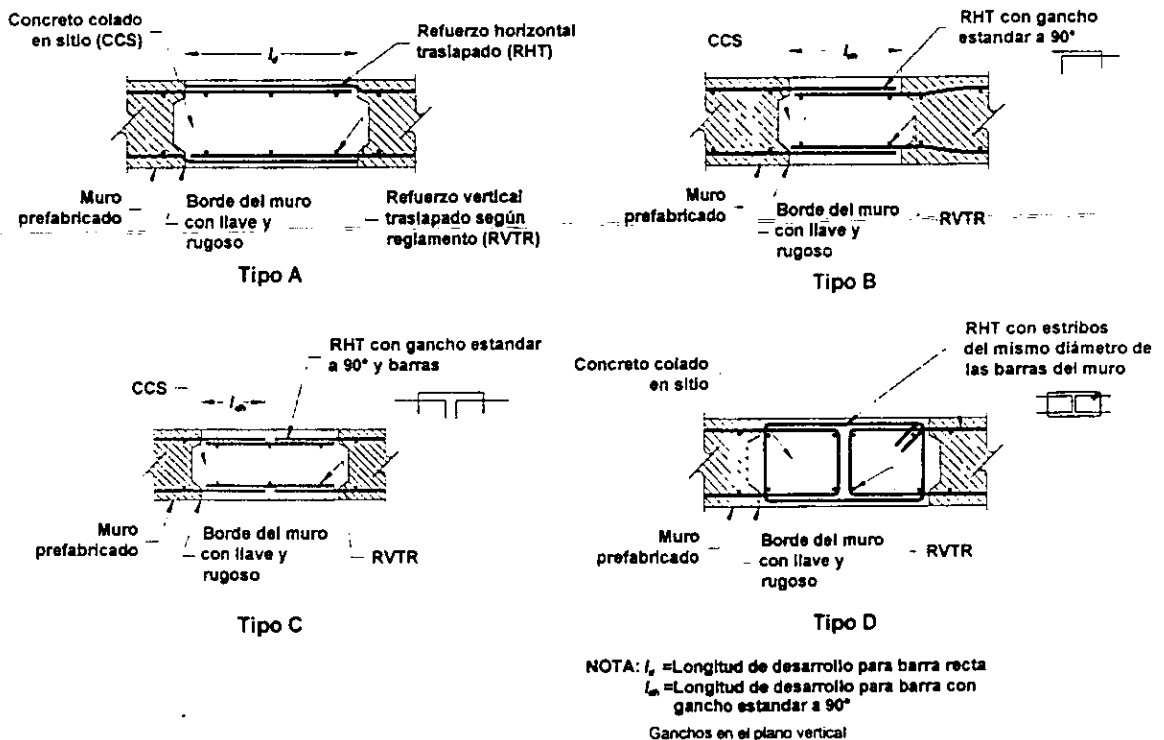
Configuraciones en planta para conexión vertical en muros prefabricados
